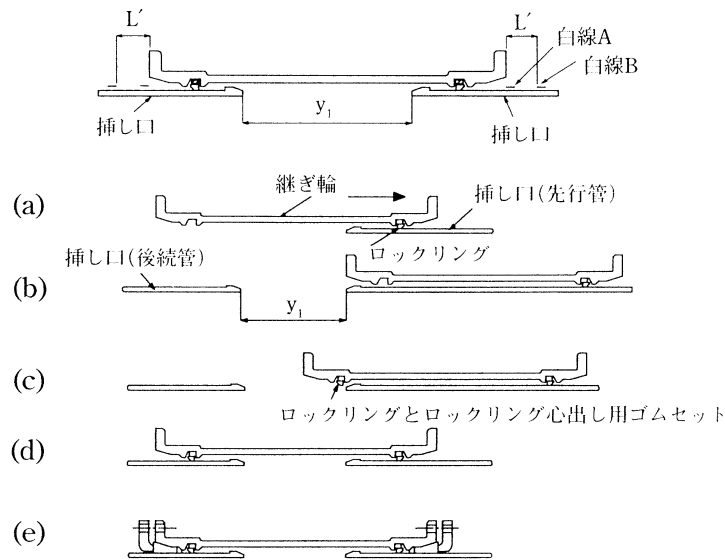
継ぎ輪の施工手順（せめ配管の場合）
